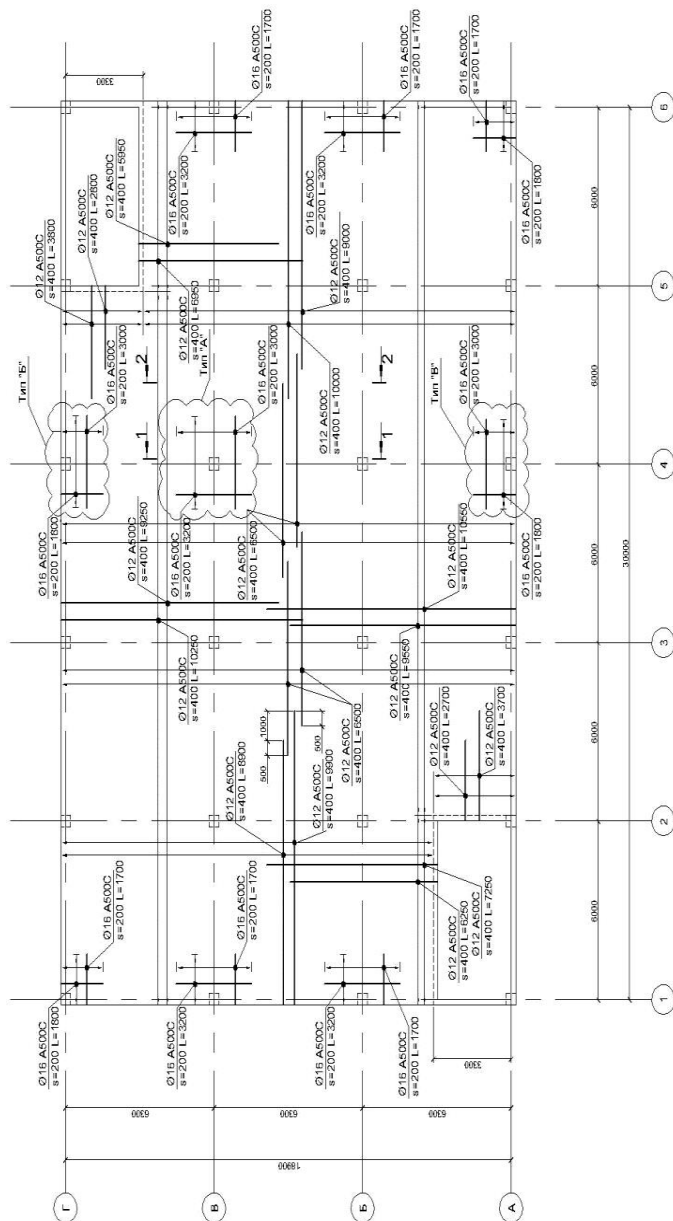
Схема верхнего армирования плиты перекрытия отдельными стержнями
